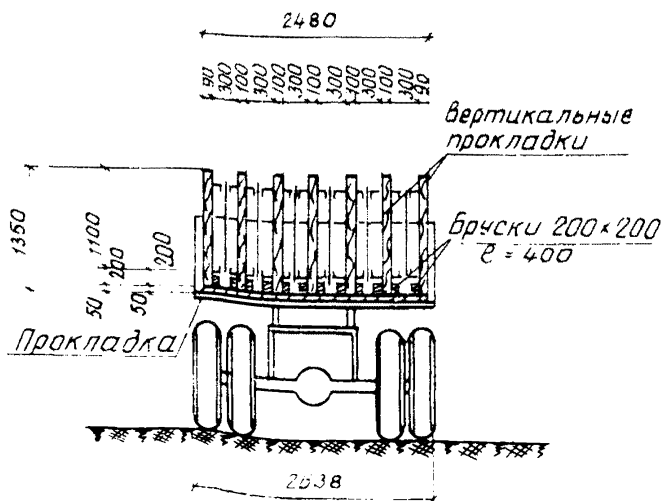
Пример пакетной укладки стропильных ферм на транспортные средства
